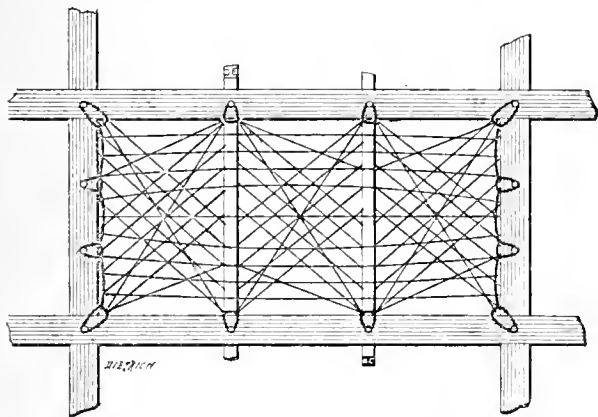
Disposition des armatures dans un plancher en ciment armé système Matrai.
